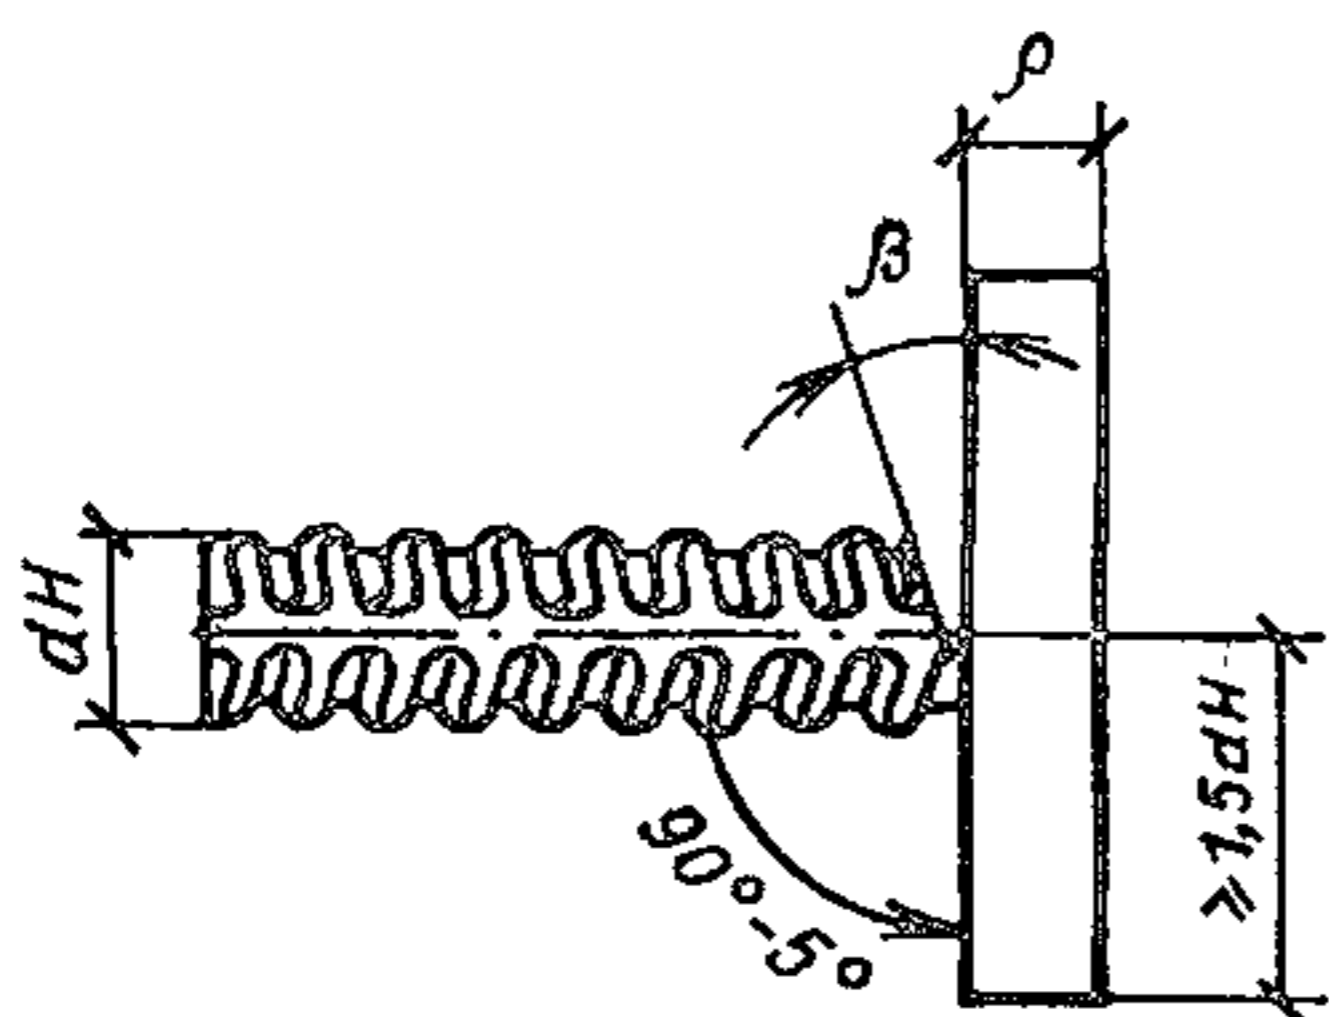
Вид подготовленных элементов для автоматической сварки под слоем флюса
